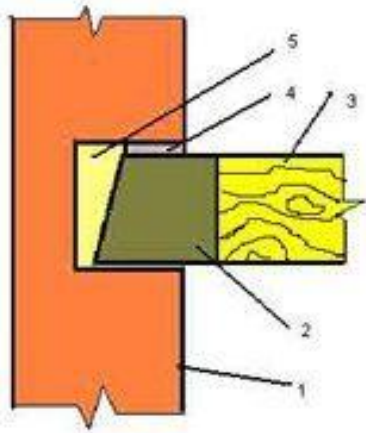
Вариант опирания деревянной балки на кирпичные стены:
